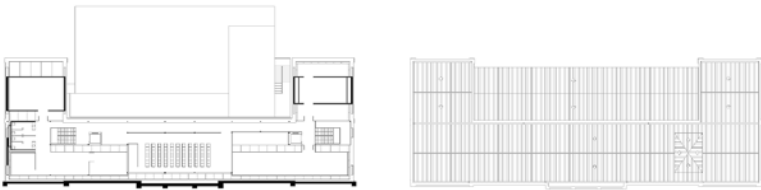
Planta cubiertas. Edificio Reutilizado/Edificio Original.
